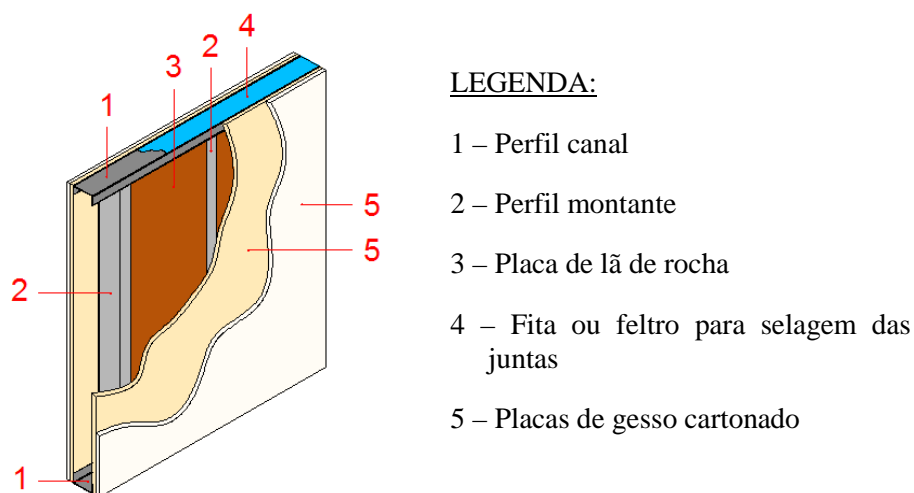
Pormenor construtivo das paredes em gesso cartonado
